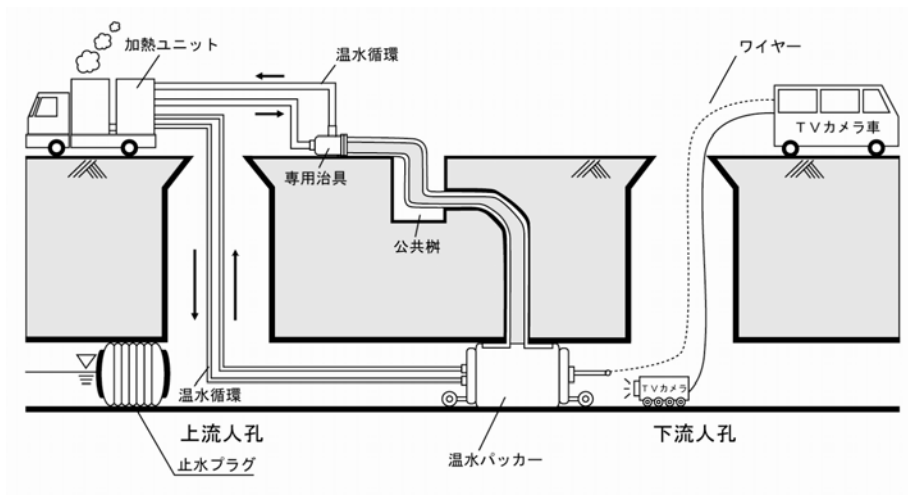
熱硬化タイプ(引込み方式)の施工概要図(例)
